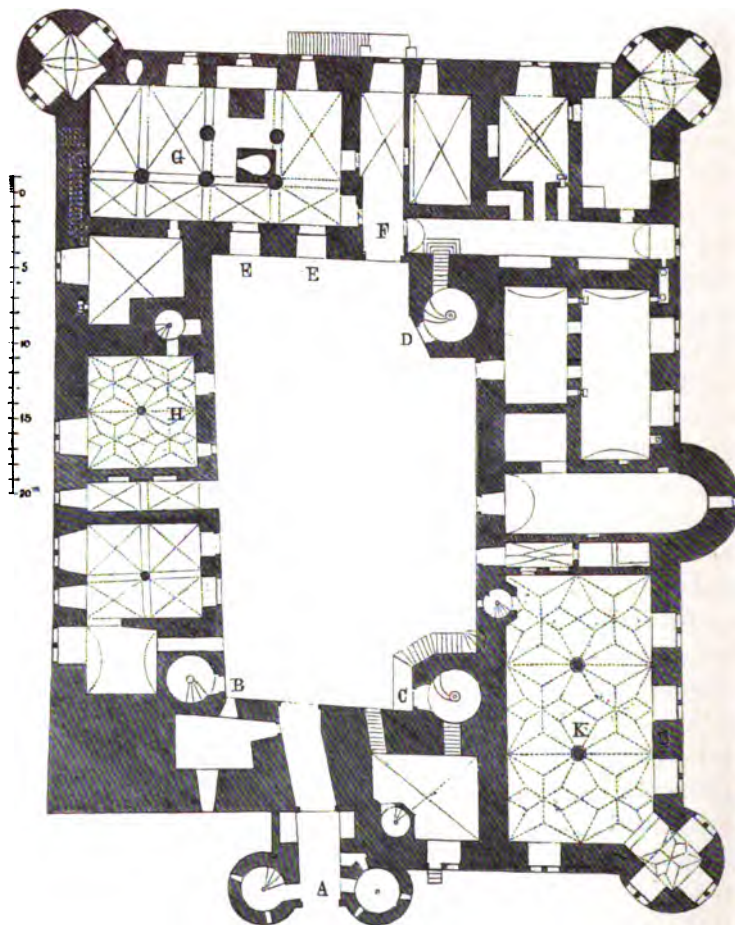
Schloß zu Neuenstein. Grundriß des Erdgeschosses.
